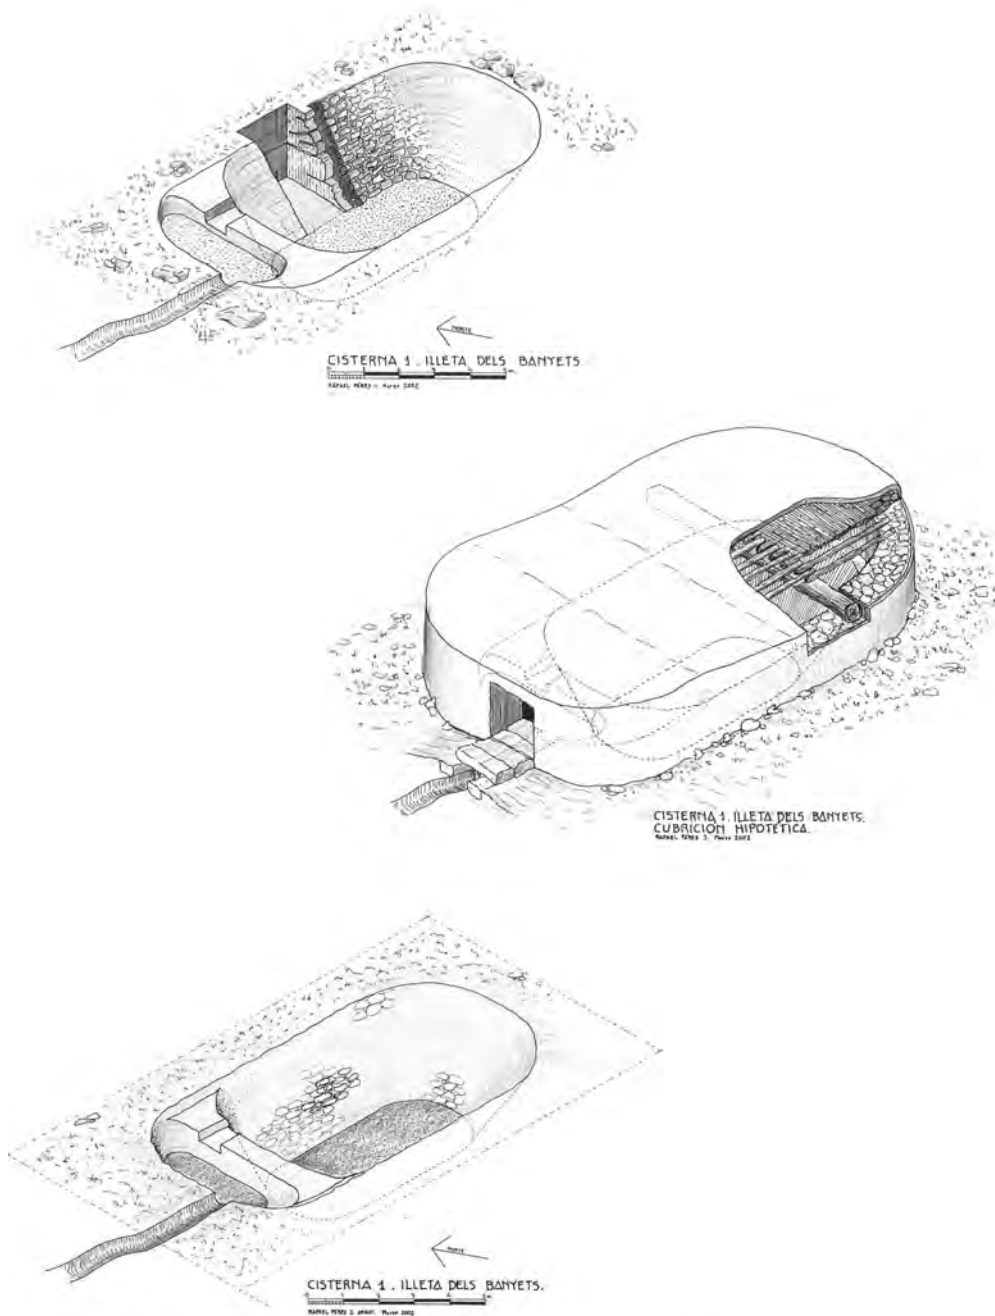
Croquis. Recoge la excavación de la cisterna nº 1, la posible disposición de la balsa de decantación y el canal de abastecimiento y una propuesta de cubrición de la estructura.
